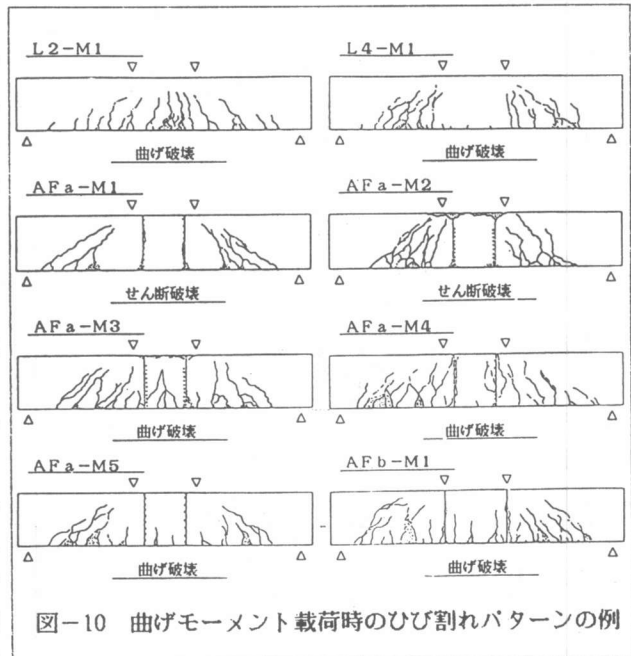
曲げモーメント載荷時のひび割れパターンの例
